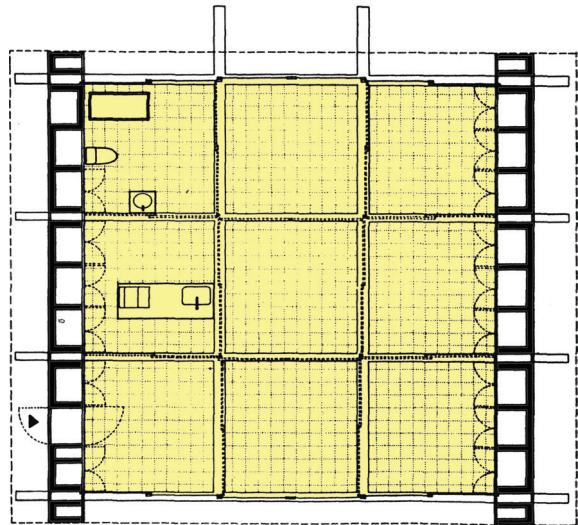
Кућа без зидова, Нагано, Шигеру Бан, 1997
